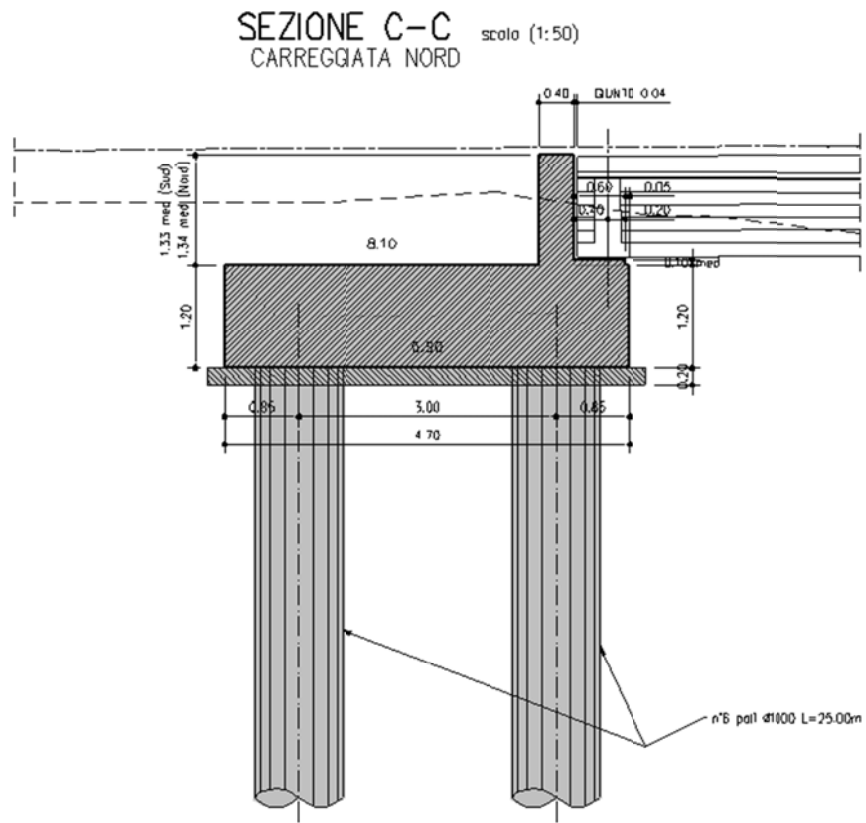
Sezione longitudinale spalla in ampliamento
